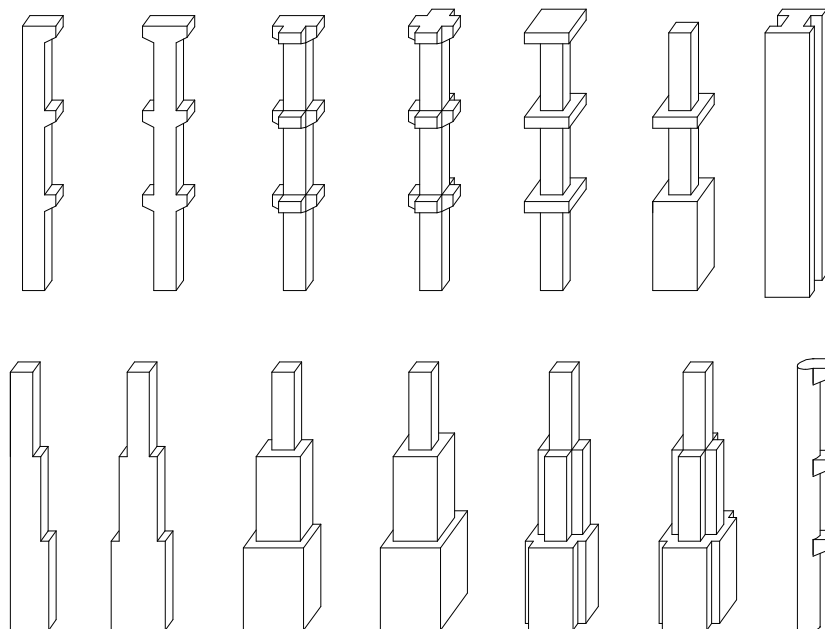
Algumas soluções possíveis de pilares pré-fabricados
